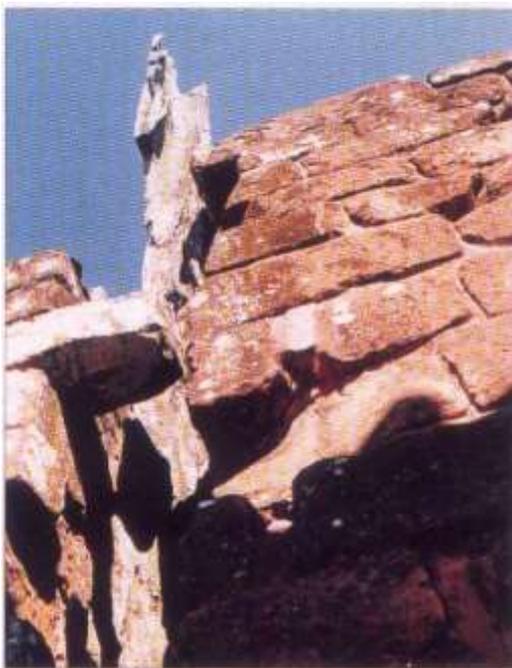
Detalle de estructura que se compondría de madera inserta entre muros. FUENTE: Propia
